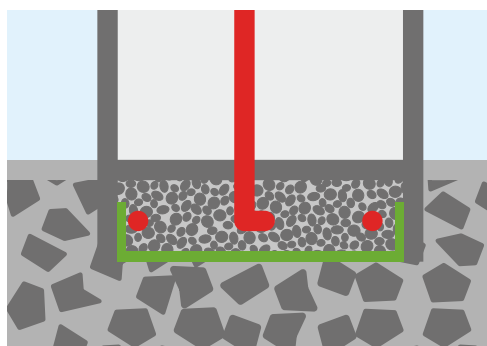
Installazione di un drenaggio radon in terreni poco permeabili (distanza tra i tubi da 1 a 3 metri).
